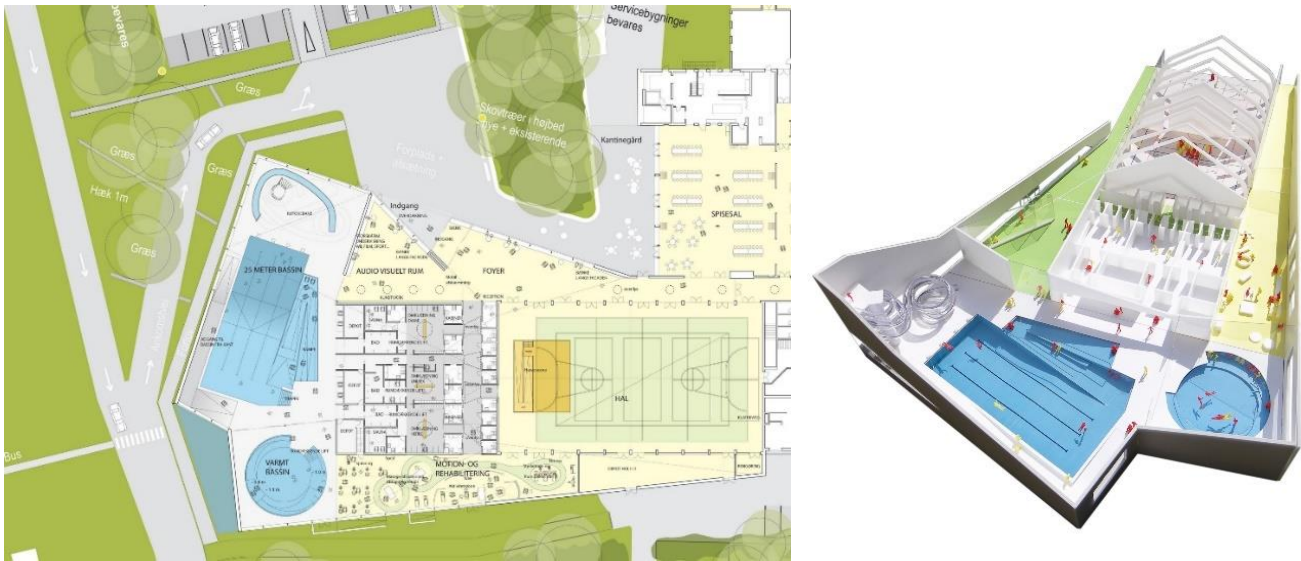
Planta Arquitectónica “Centro de rehabilitación Vandhalla”
